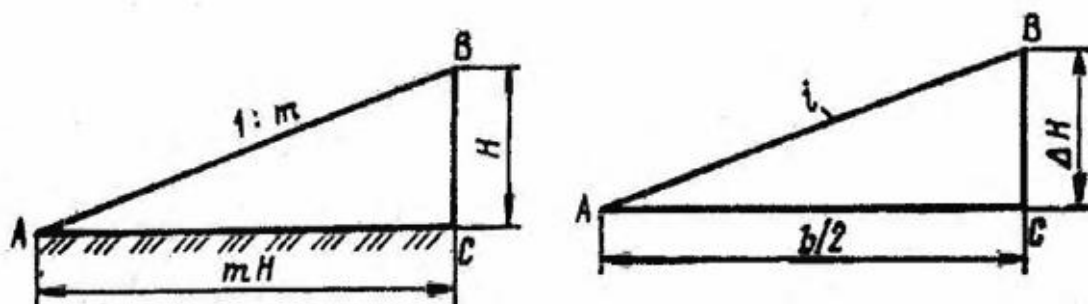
Схема к определению крутизны откоса насыпи и поперечного уклона проезжей части
